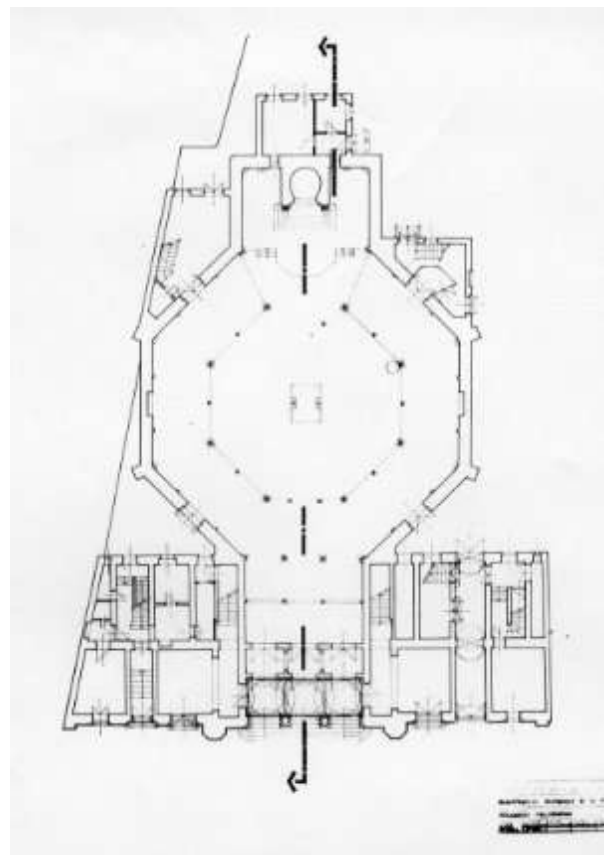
Grundriss Erdgeschoß 1971 Vermesserplan 1971
